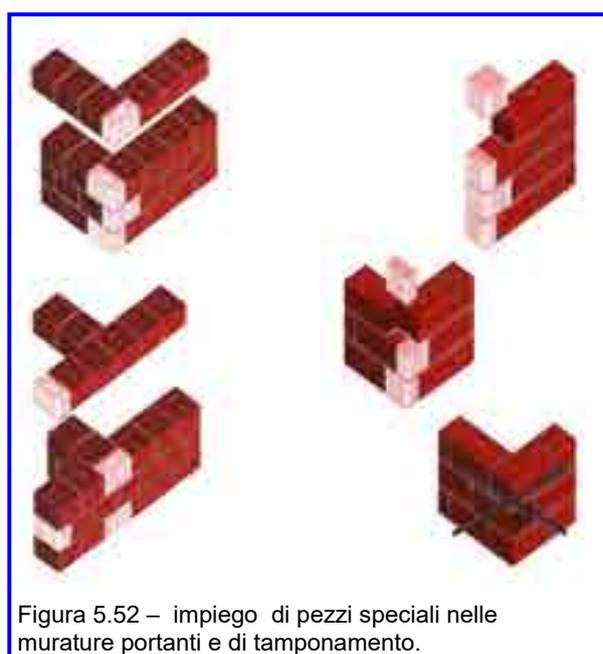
impiego di pezzi speciali nelle murature portanti e di tamponamento.
